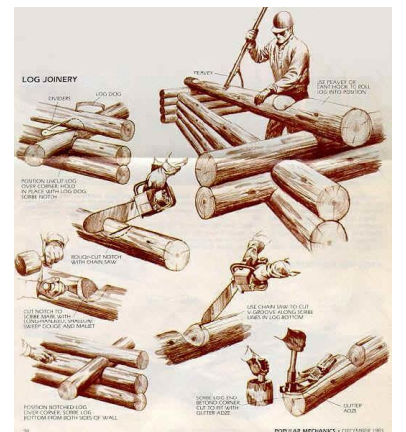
Instruções para a construção de uma casa de troncos; (Chotiner, 1983)
